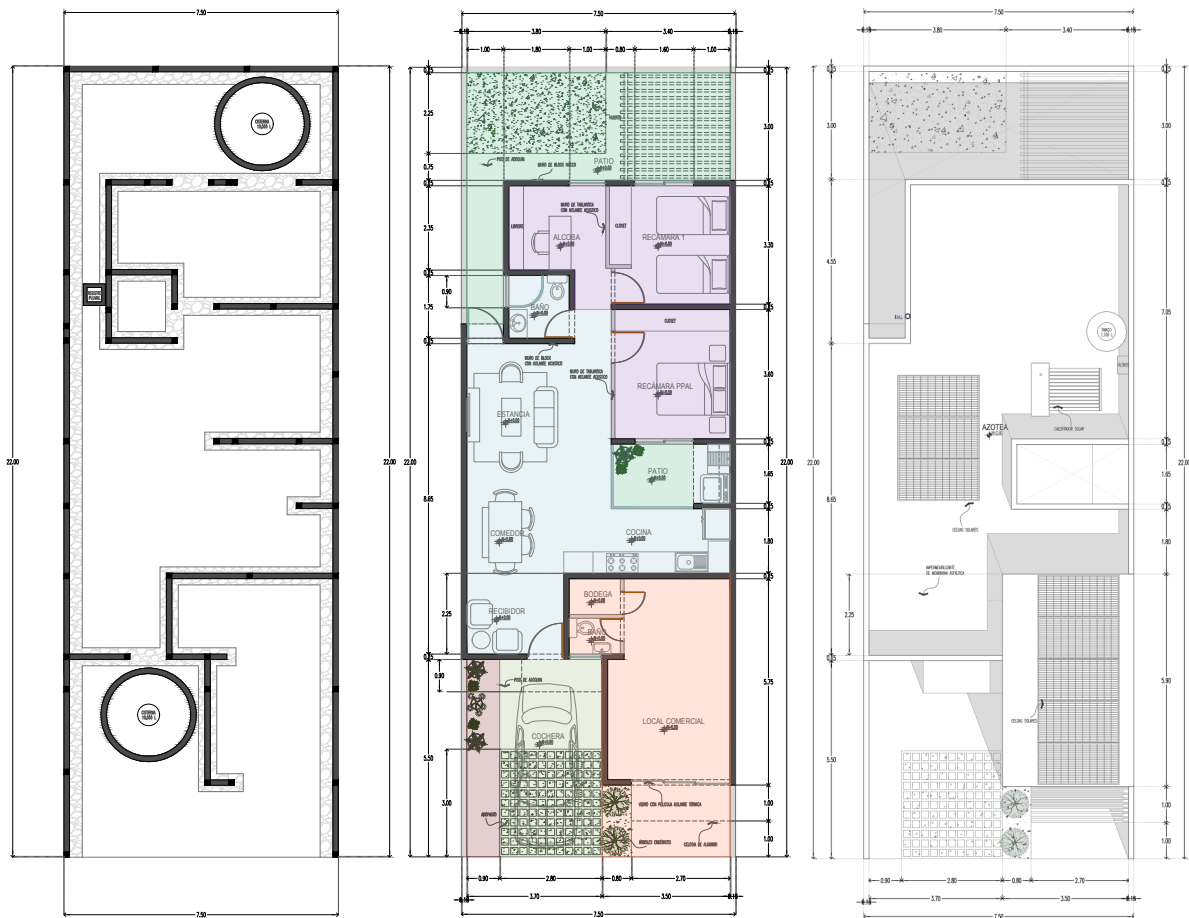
Planta de cimentación, planta baja y planta alta de etapa 2.
